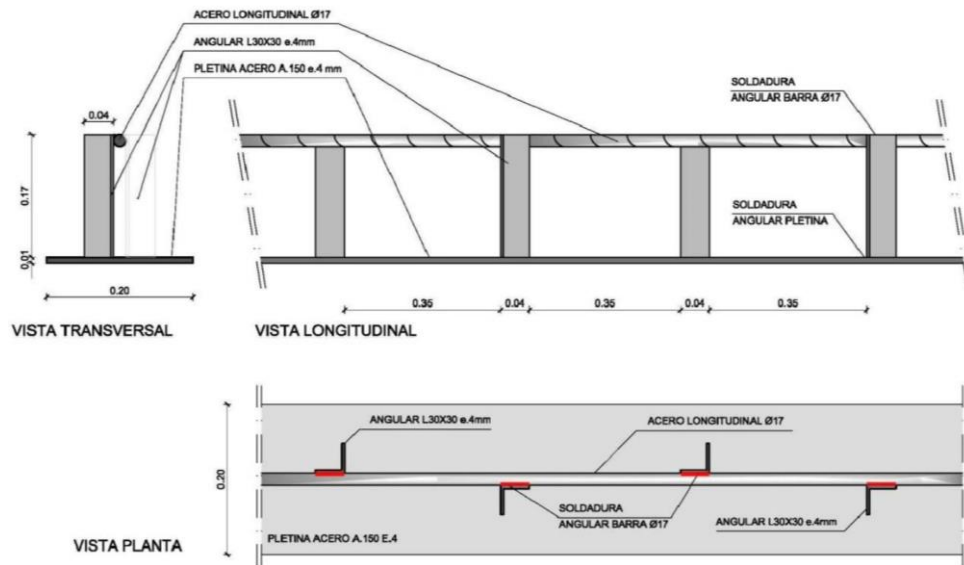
Edificio La Viña (lorca). Detalle del refuerzo encontrado en las vigas del edificio (Ratzlaff, 2011)
